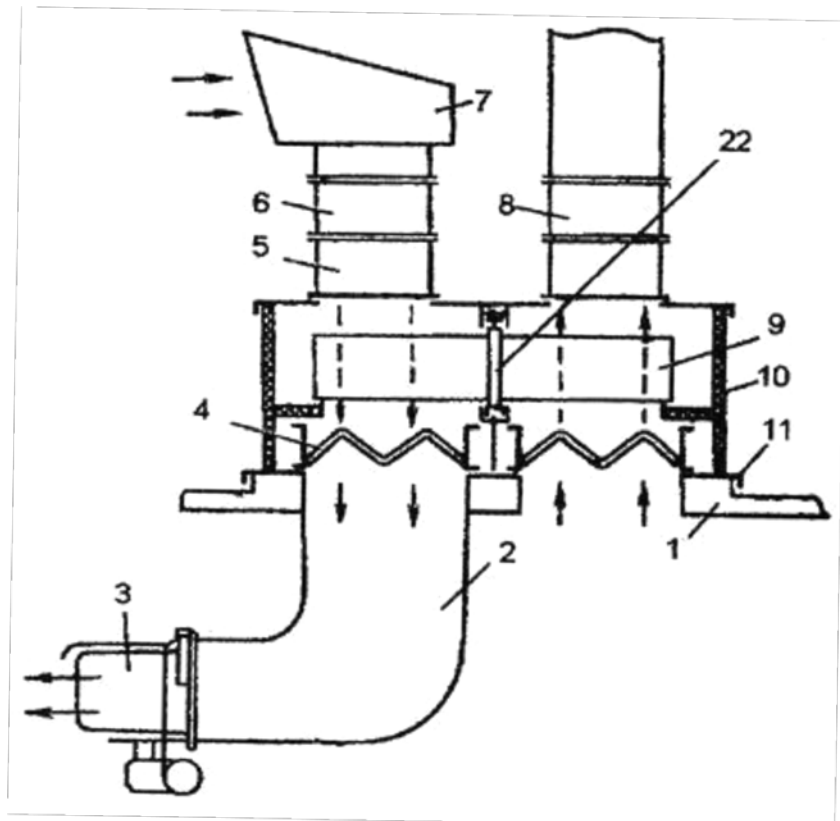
Приточно-вытяжная установка с вентилятором
